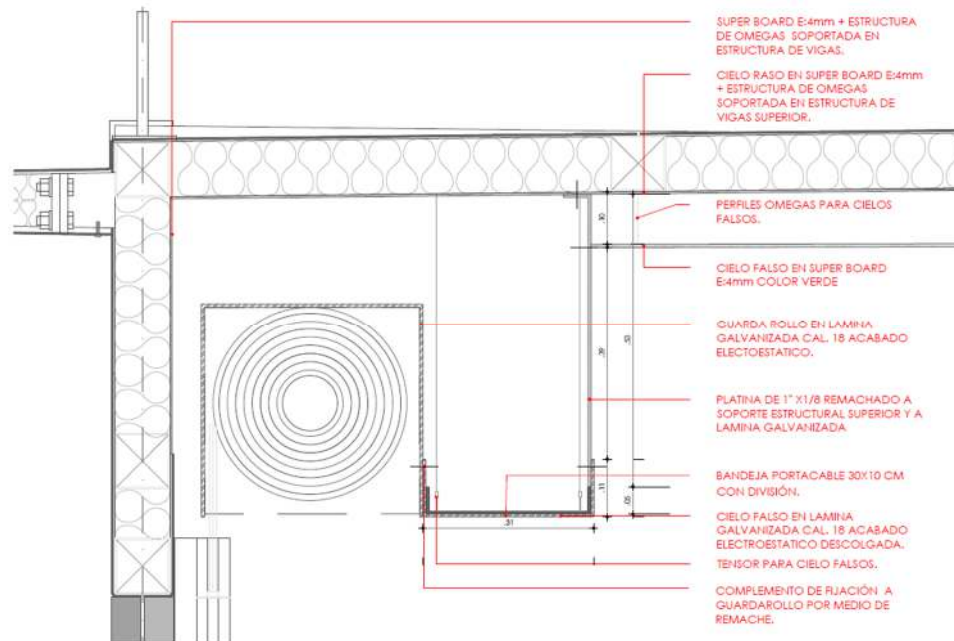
Instalación de lámina galvanizada remachada a las vigas estructurales de cubierta y a guarda rollo. Plano 12. A-302 CORTE GENERAL 3 - 4.dwg
